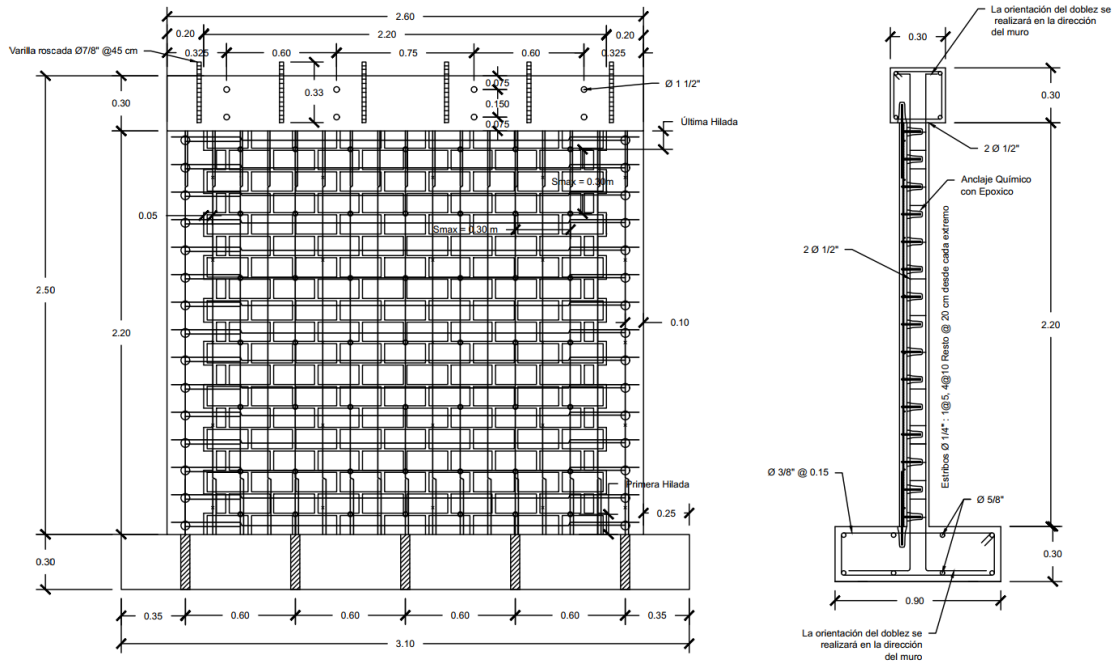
Espécimen a escala real de muro de albañilería reforzado con malla electrosoldada
